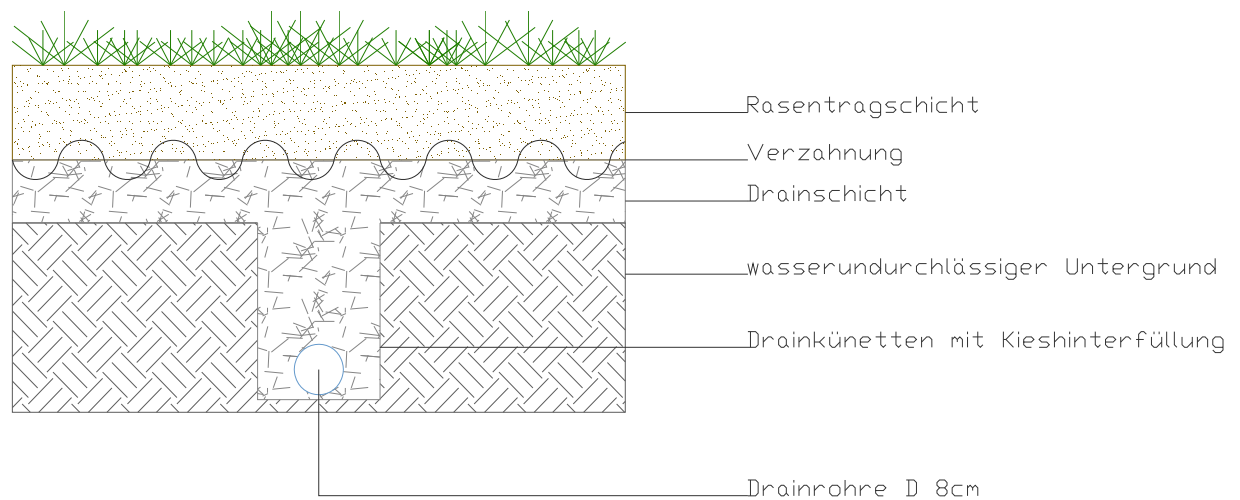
Flächendrainage mit Rohrdrainung (ÖNORM B 2606-1)
